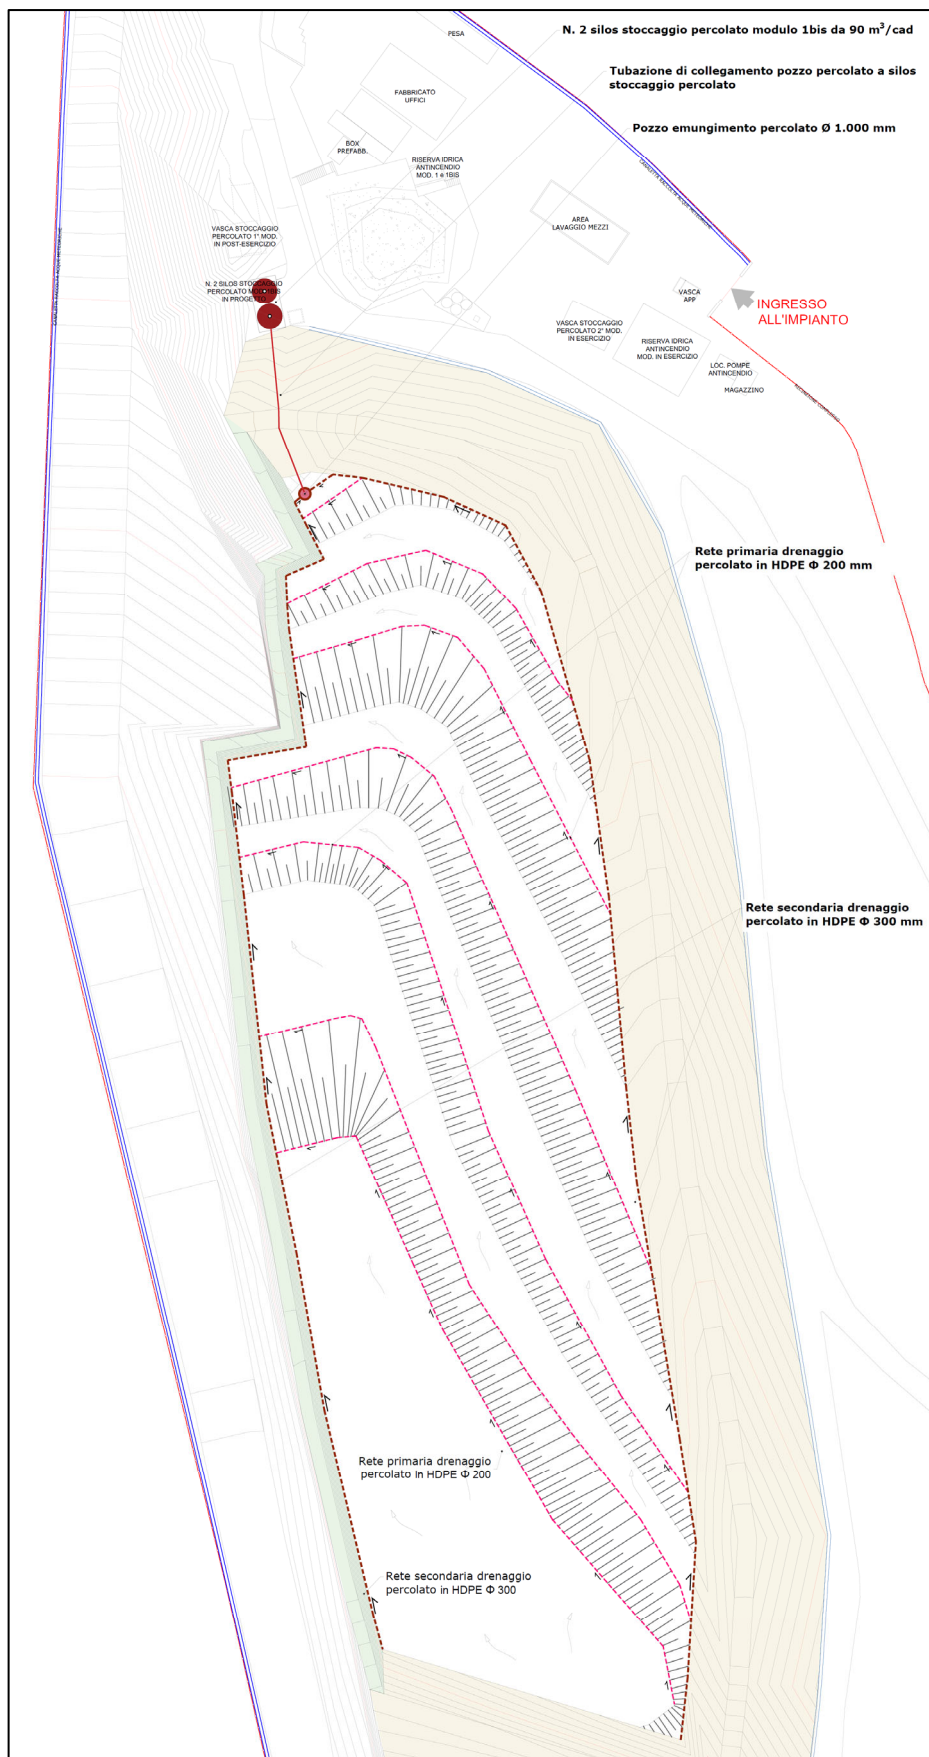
/XIII: Planimetria rete drenaggio percolato
